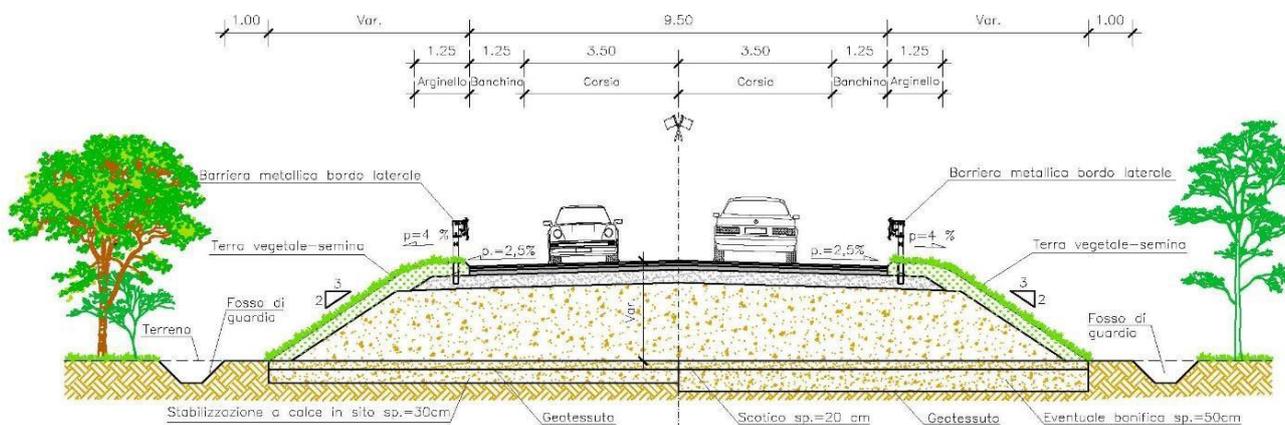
Sezione tipo C2 in rettilineo attraversamento abitato di Tai di Cadore
